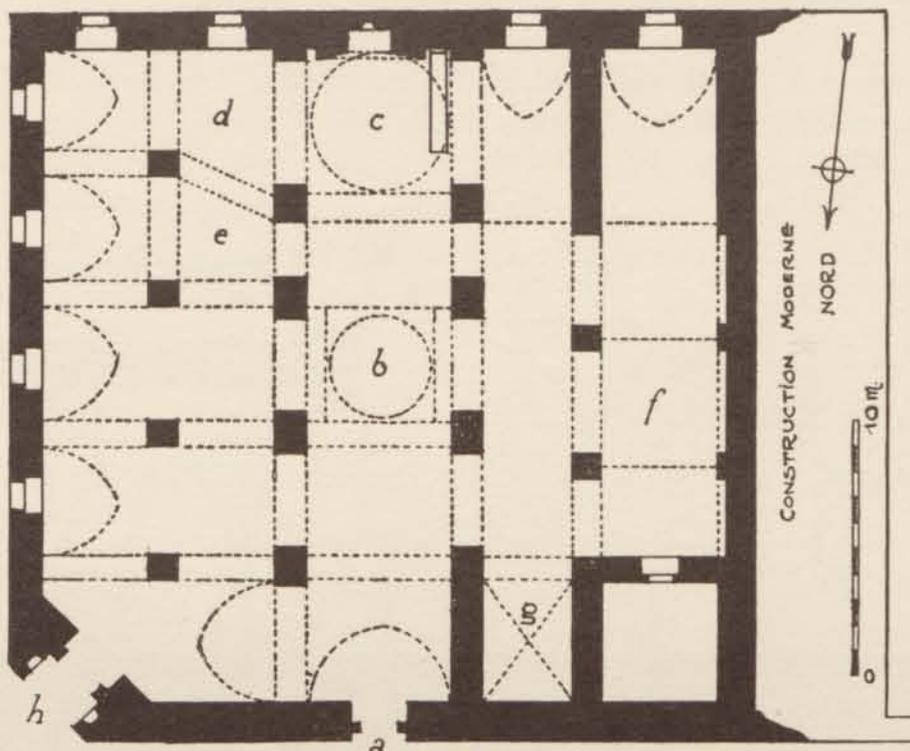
KÜÇÜK (?) DJAMI: Plan.
